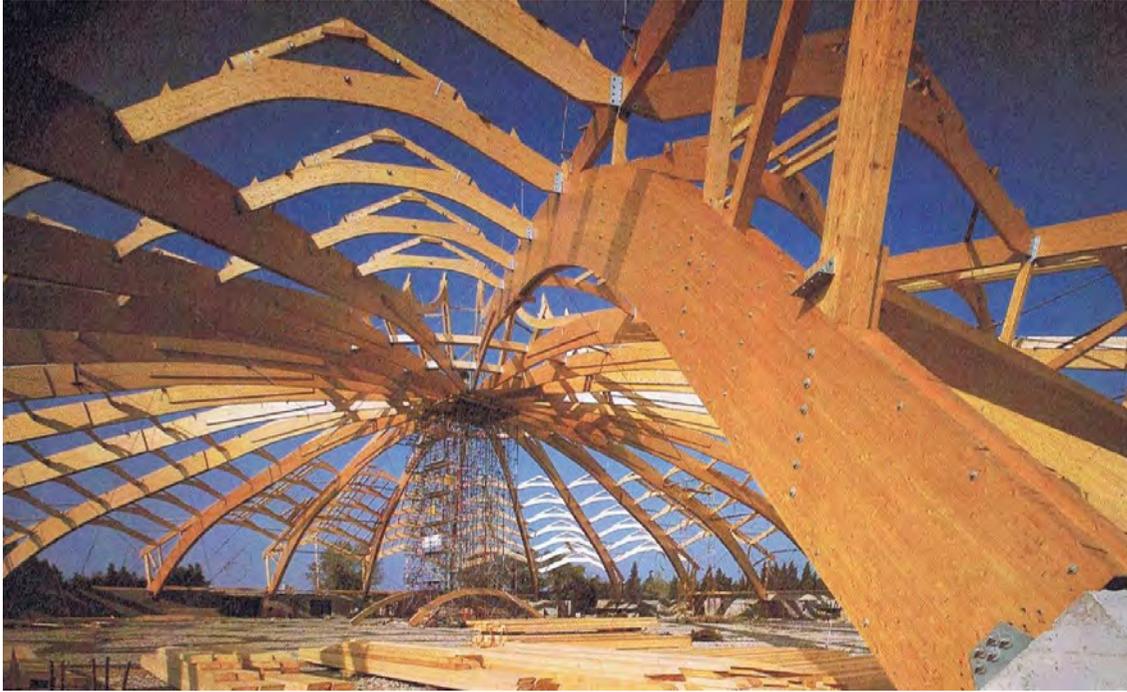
Avignon, große Ausstellungshalle, Montagezustand, aus /145/
